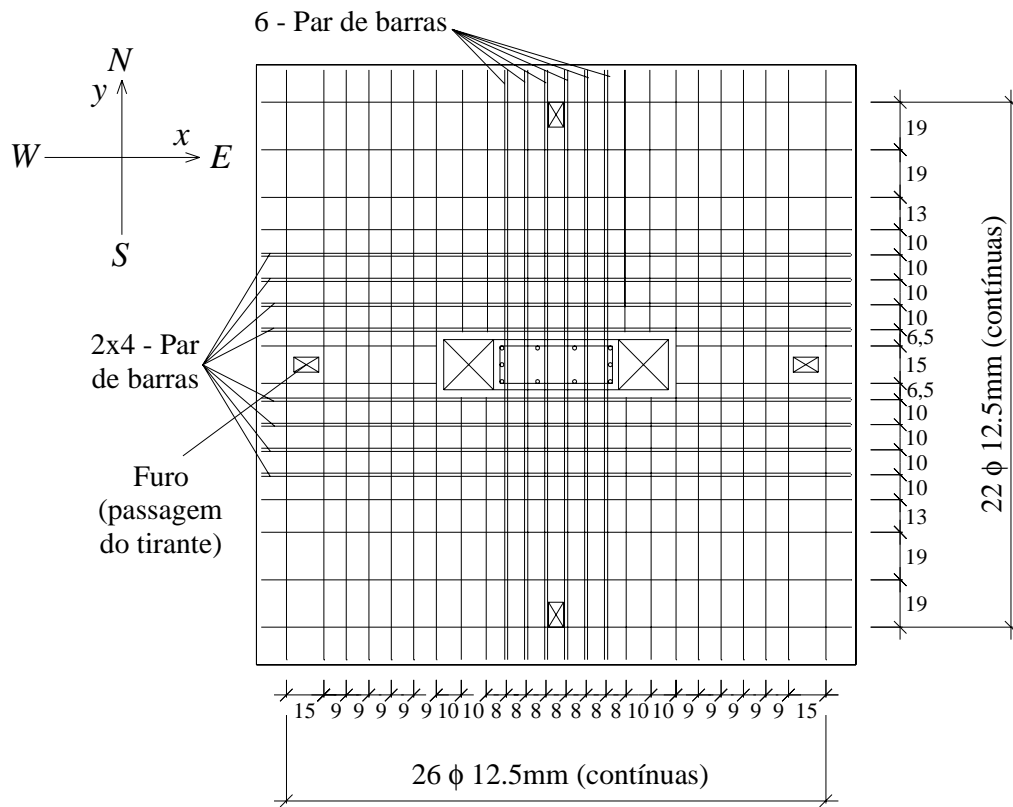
Armadura de flexão das lajes L9 e L10, L13 (cm)
